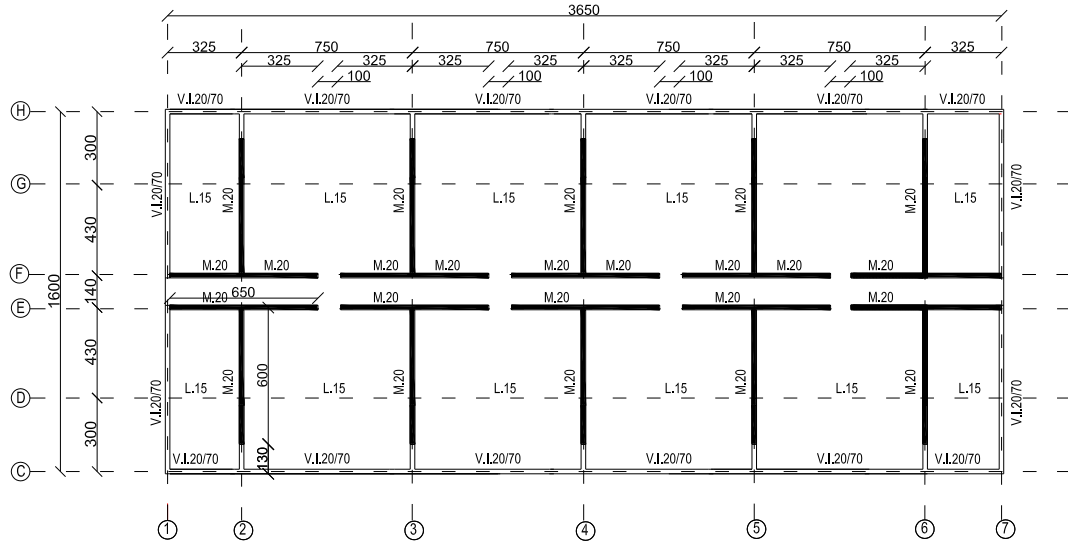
Planta estructura nivel 20-11°, edificio aislado. Esc 1:350
